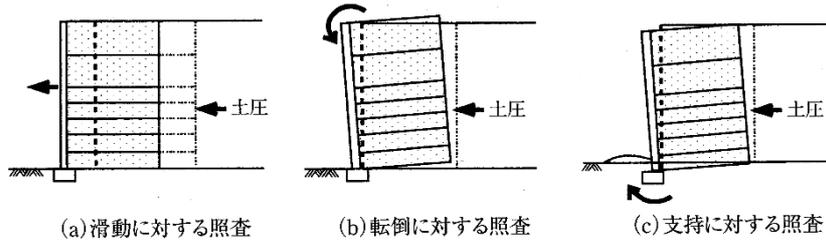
補強土壁自体の安定性の照査項目⁸⁾
